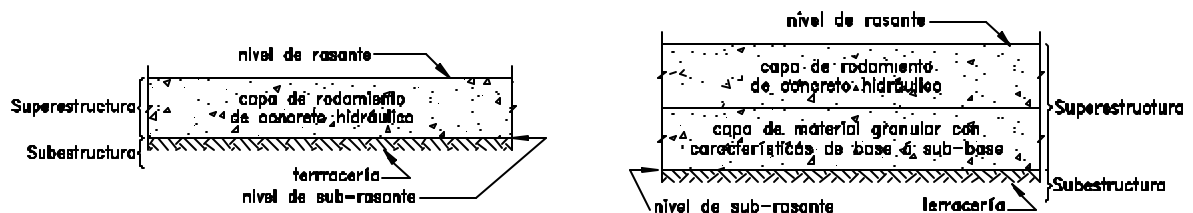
Capas y niveles en la estructura de pavimentos rígidos.
